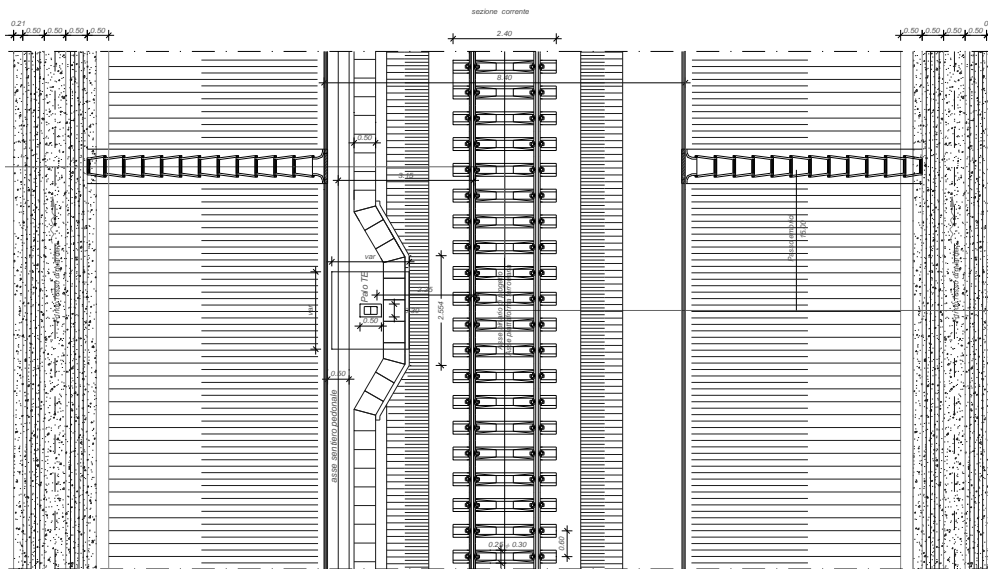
Stralcio planimetrico per sezione tipo ferroviaria in rilevato a singolo binario (piattaforma in retto) con $H_{ril} \leq 6,00$ m
